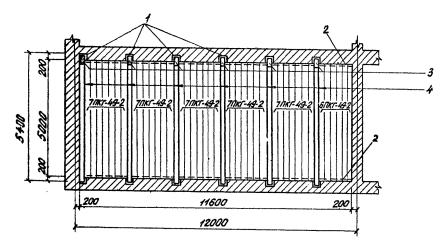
План участка перекрытия из железобетонных плит ПКГ-51-2 с опиранием на протесн ПР-2 и плит ПКГ-49-2 с опиранием на пристенные балки МБО-1: 1 - существующие гнезда; 2 - пристенные балки МБО-1; 3 - протезн ПР-2; - плитн ПКГ-51-2.
